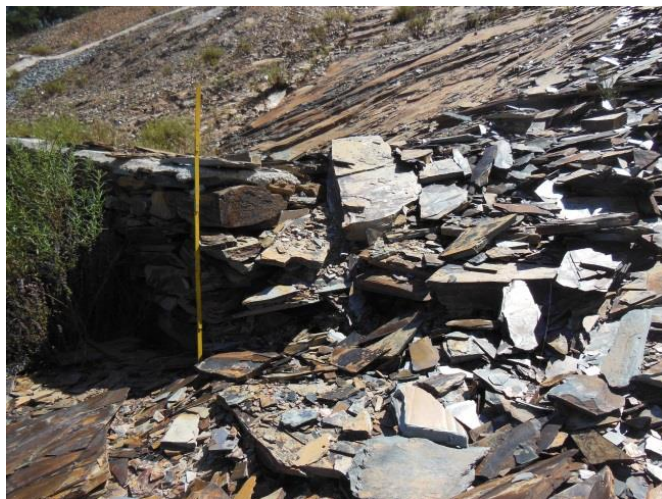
Pormenor da zona 3.4 do Talude 3 em Junho de 2014, com destruição parcial do muro de protecção
